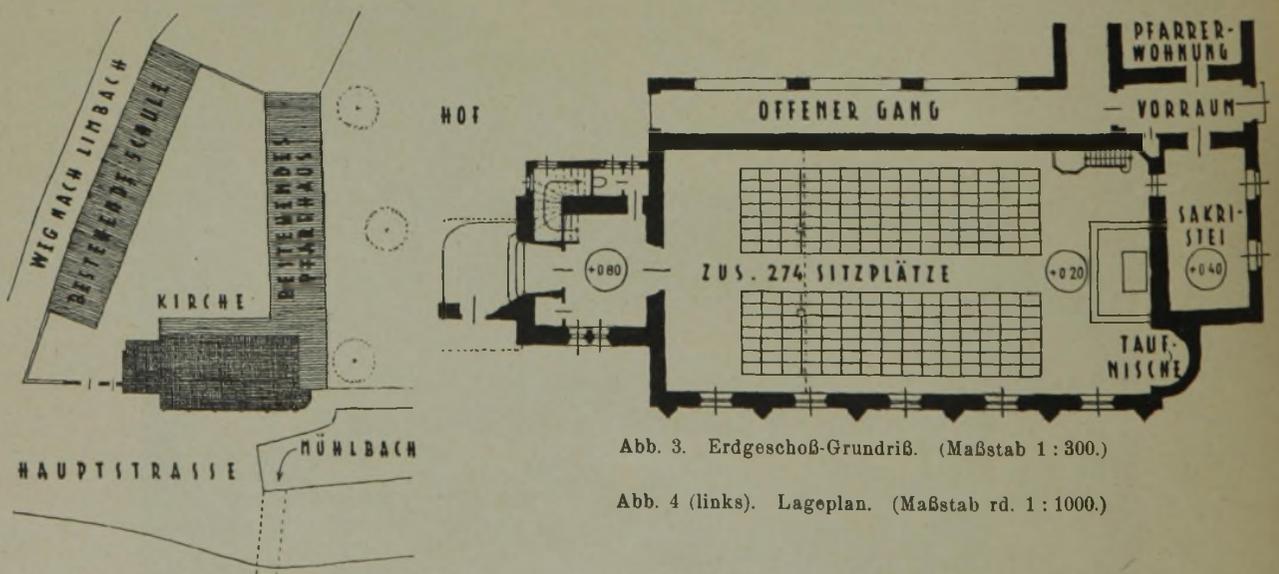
Erdgeschoß-Grundriß. (Maßstab 1 : 300.)
